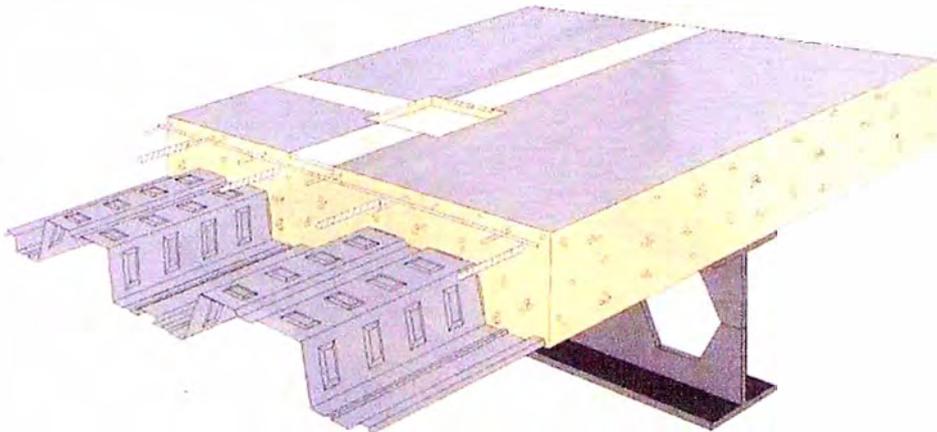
Encofrado estructural, detalle de losa colaborante
